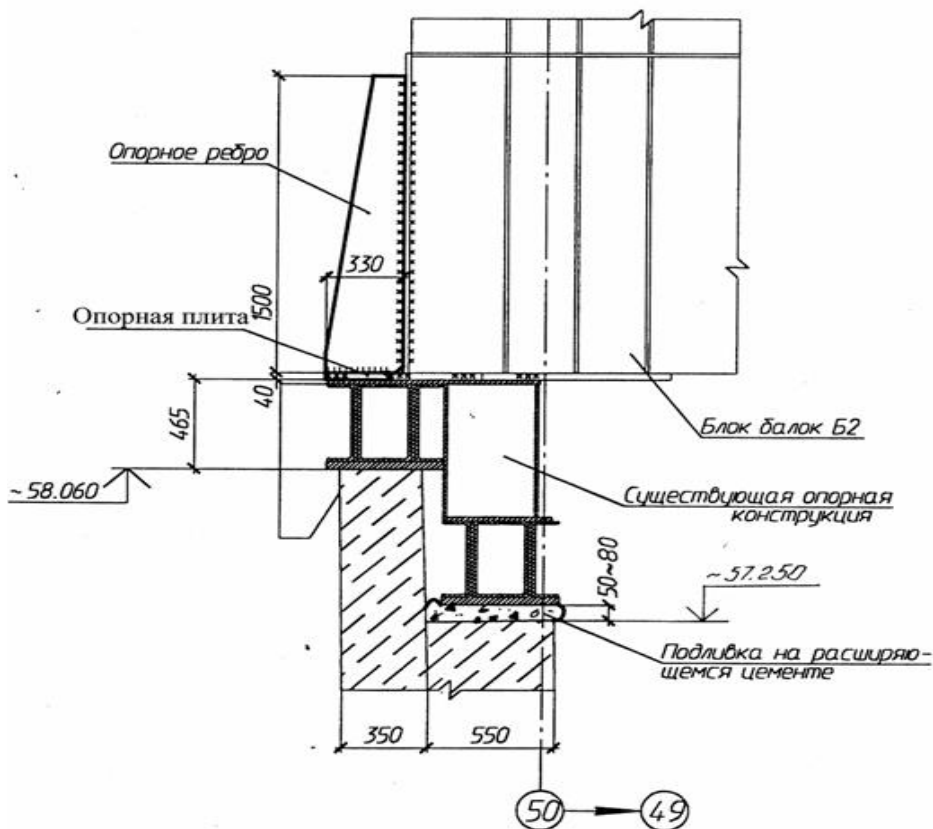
Усиление опорных частей балок Б2 и металлической опоры под балки Б2 в месте опирания блока балок Б2 на железобетонную стену по оси 50 (ряд П).
